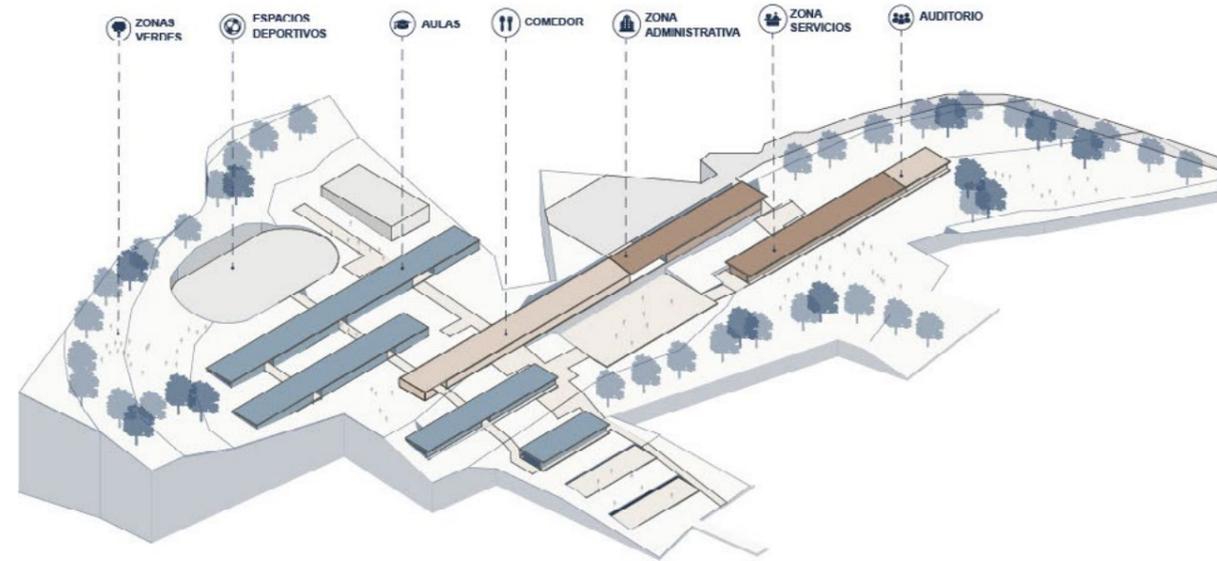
Zonificación. Fuente: Elaboración propia, 2025.
